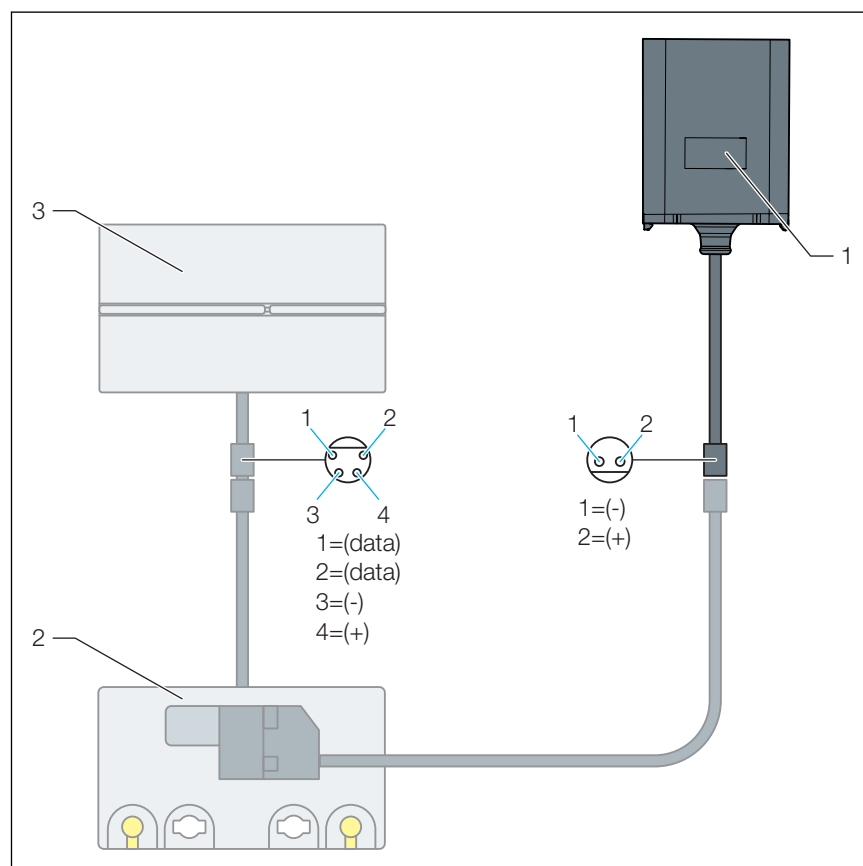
Tilslutningsskema, batterikasse, WC betjeningsplade til Prevista
